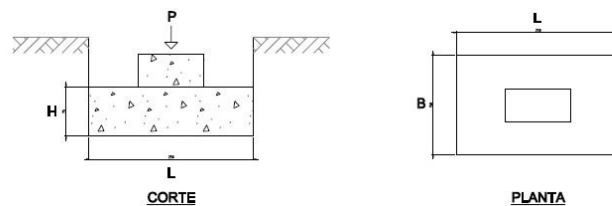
Vista en corte y planta de una zapata (Albuquerque, 2014)
